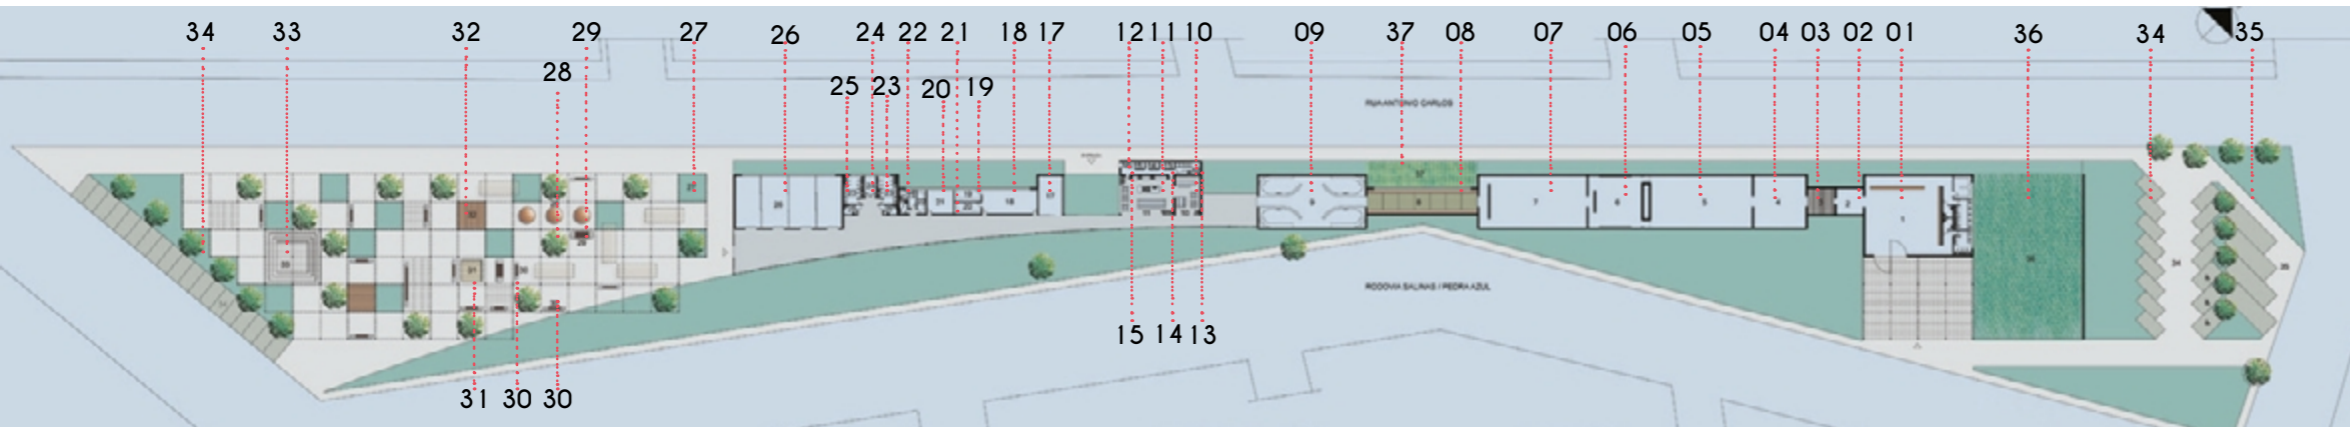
Planta geral. Fonte: Archidaily, 2021.
